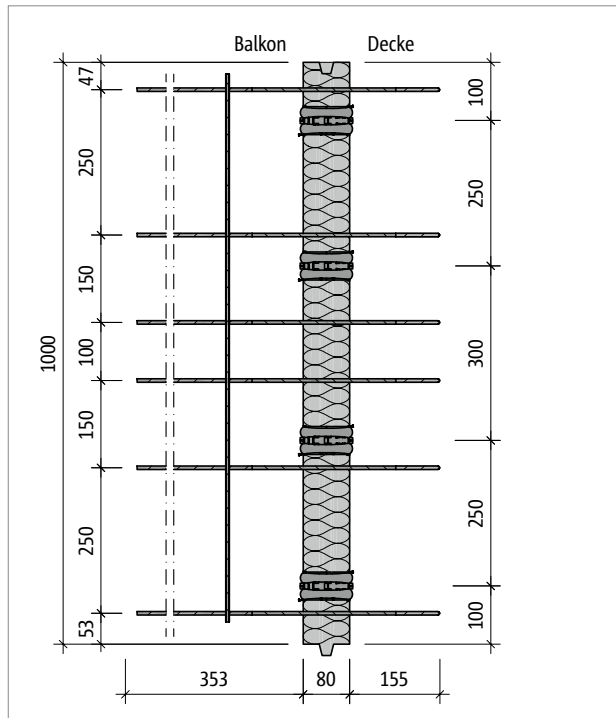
Schöck Isokorb® T Typ QL-V1: Produktgrundriss
